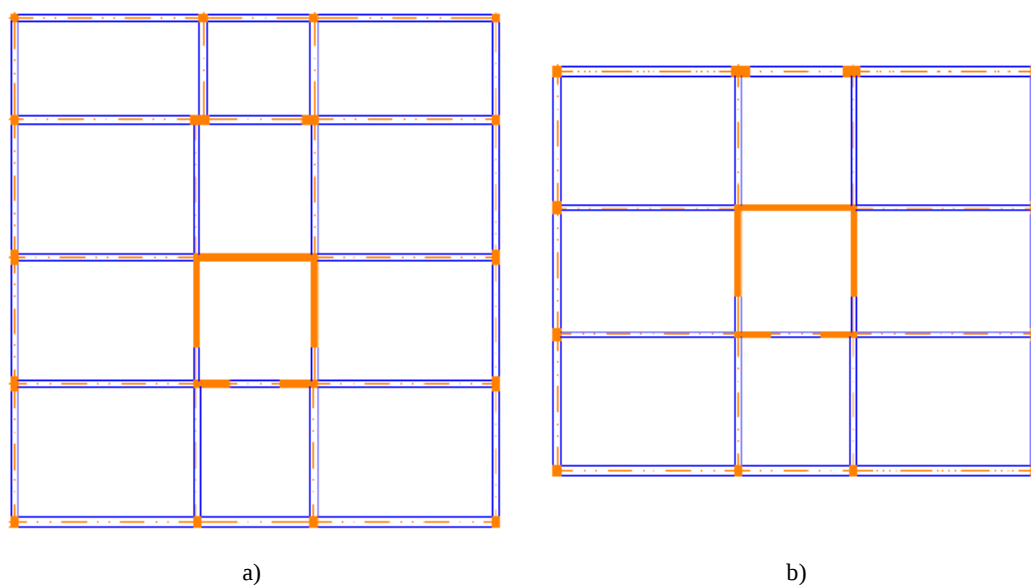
Planta estrutural: a) rés de chão; b) pisos correntes (Moutinho, 2015)
